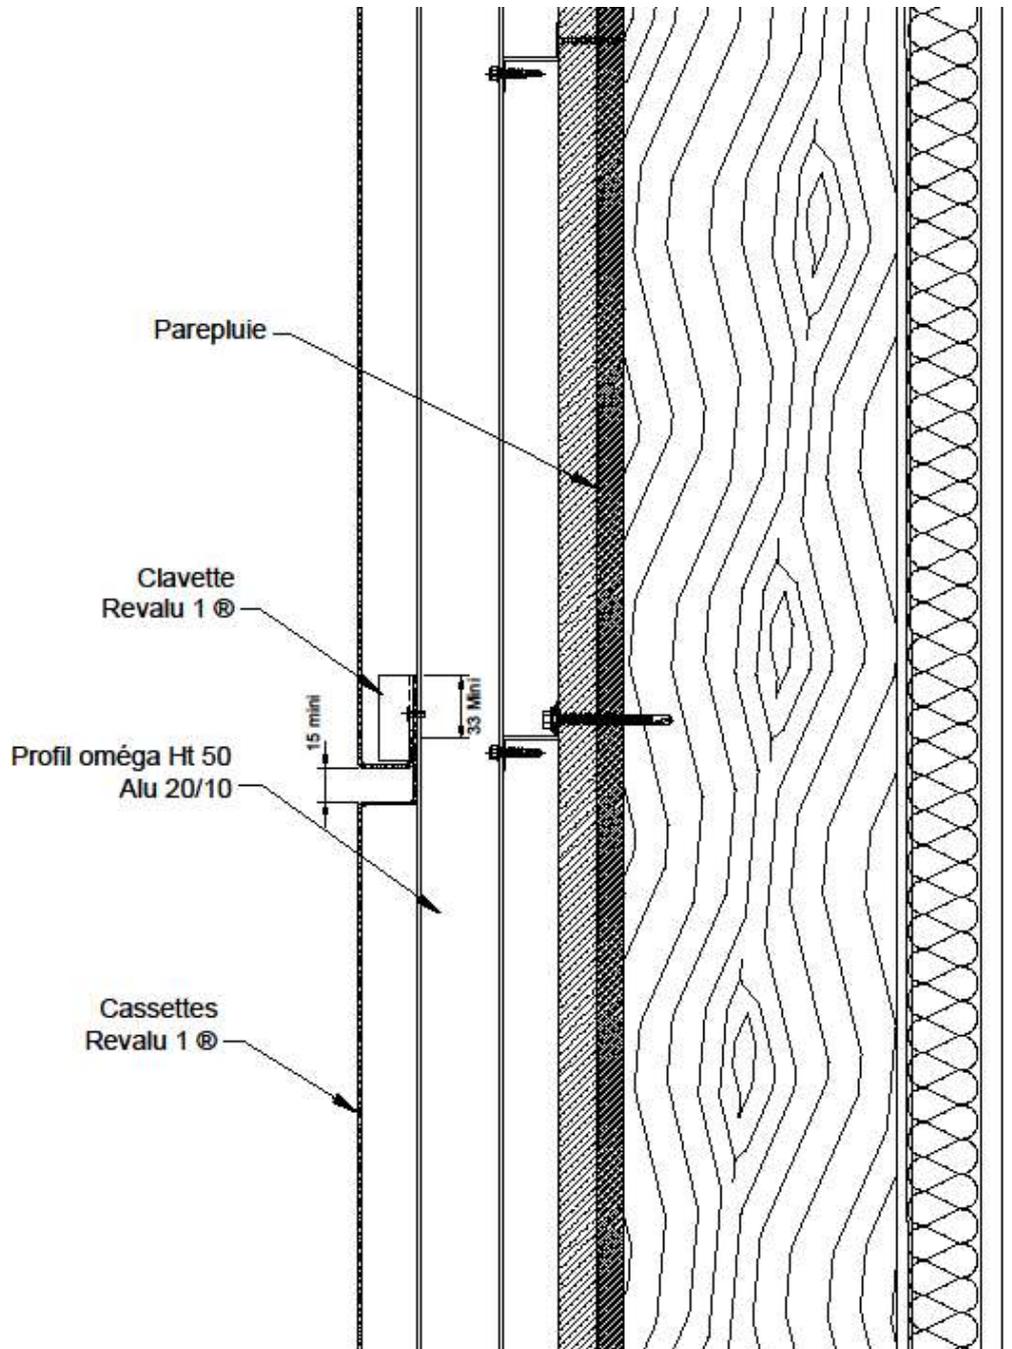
Coupe verticale sur joint horizontal (support MOB)
